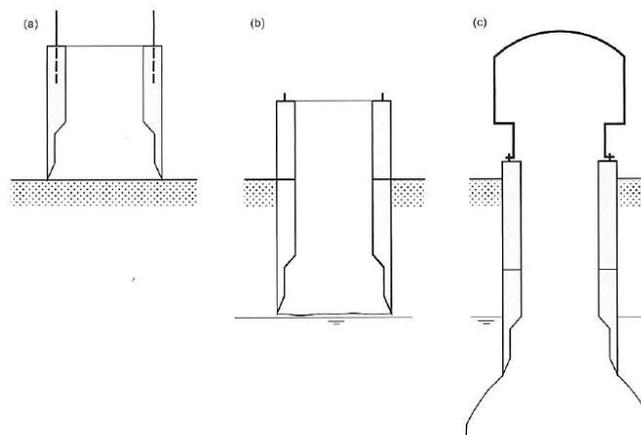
Execução de tubulão pressurizado com escavação mecânica do fuste: (a) escavação do fuste; (b) alargamento de base; (c) concretagem da base concluída (e campânula retirada).
